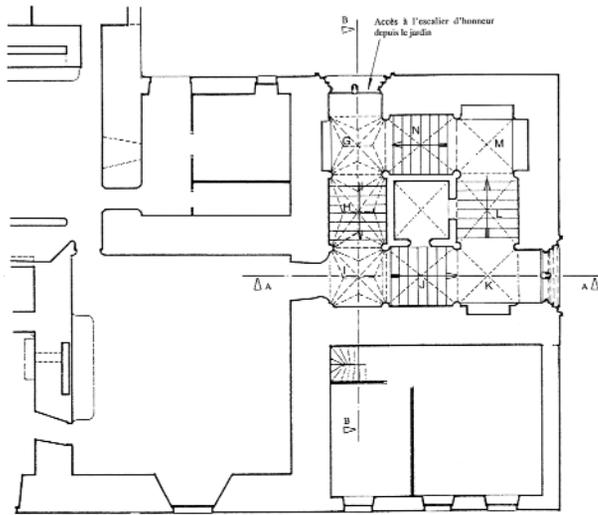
Larrazet, château, plan de l'escalier (fonds M. Soulet, dessin J.-L. Rebière, 2002).
